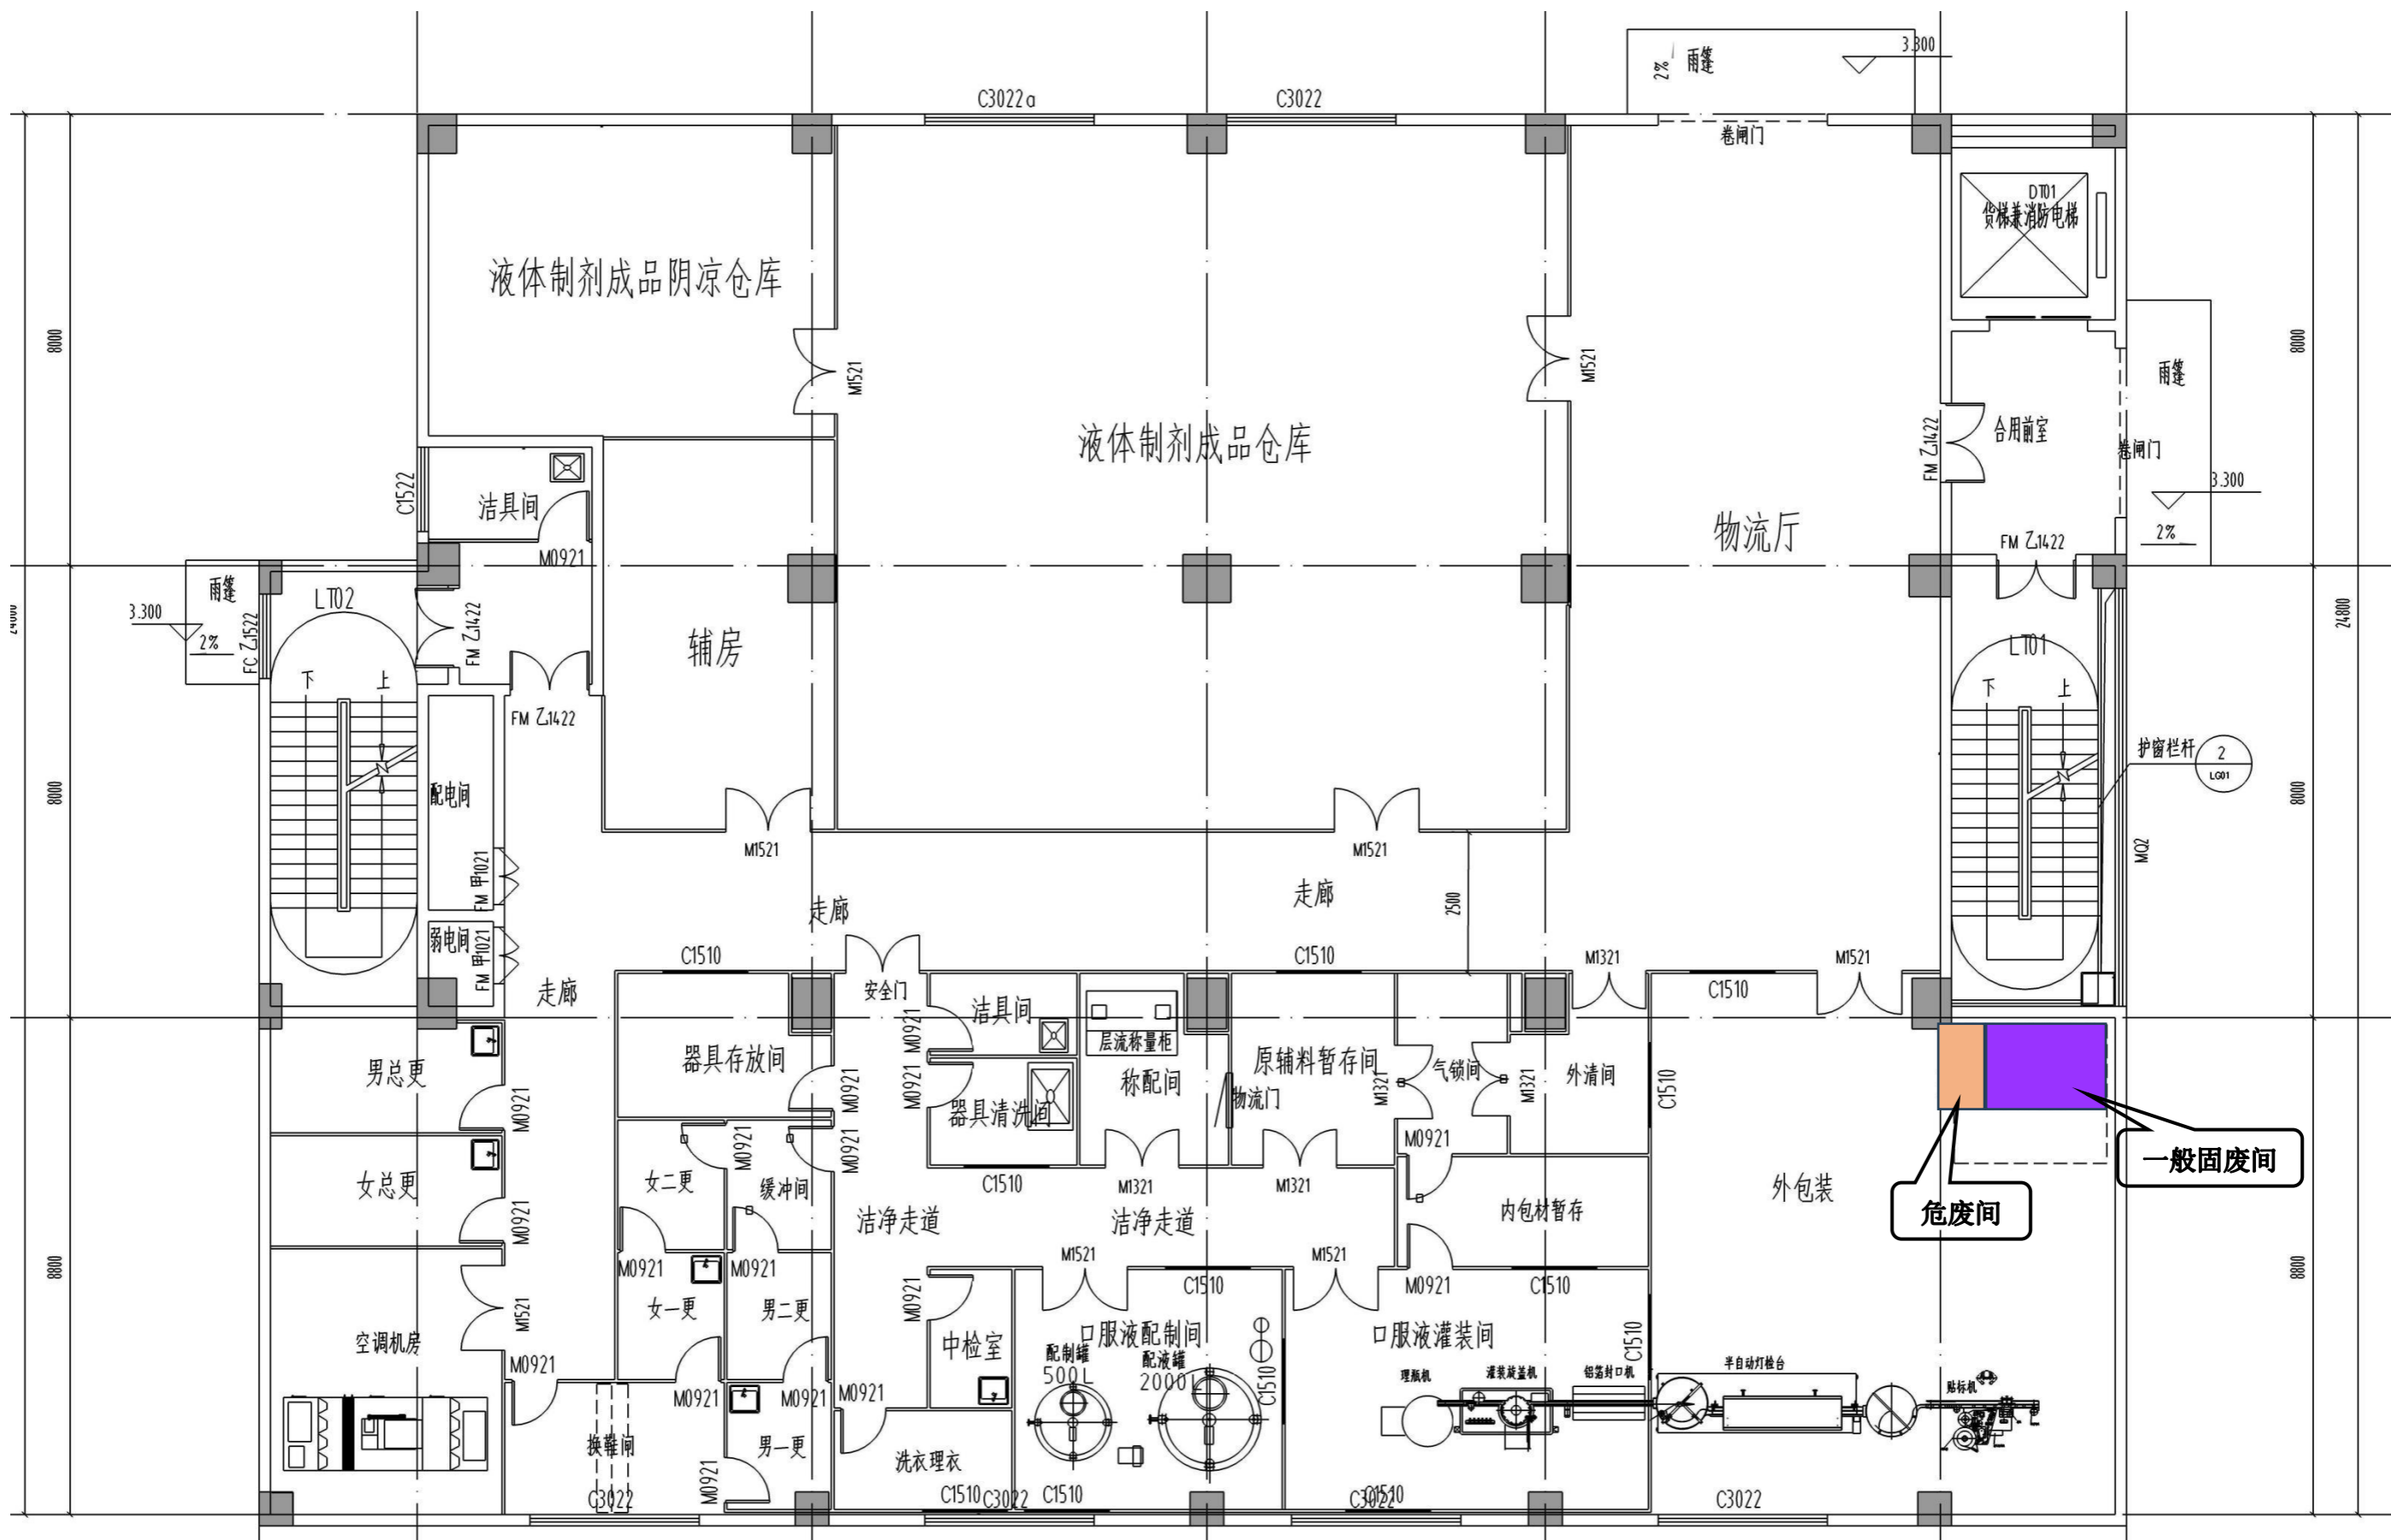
一层（备用车间、液体成品仓库）平面布置图（比例尺 1:100）
